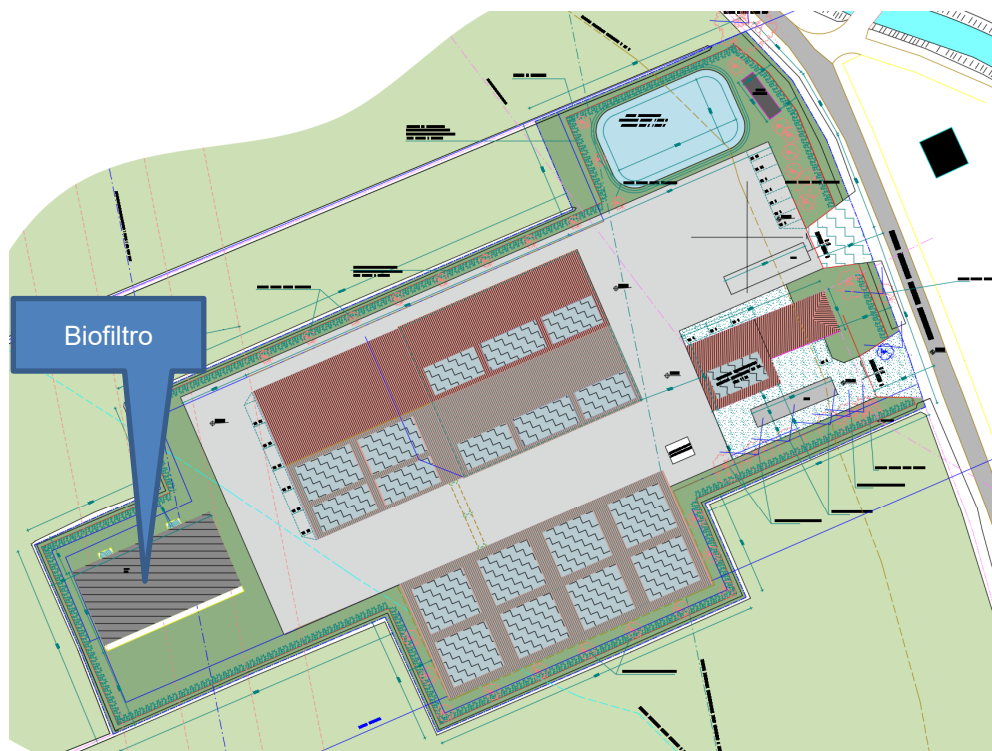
Estratto della planimetria di progetto con indicazione della posizione del biofiltro.
